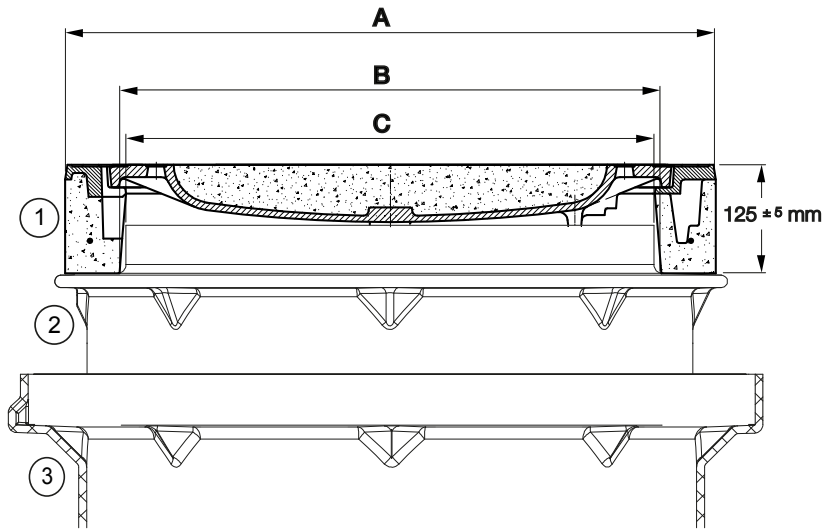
Couvercle de classe B125 monté sur la relevage - schéma de section transversale et dimensions
